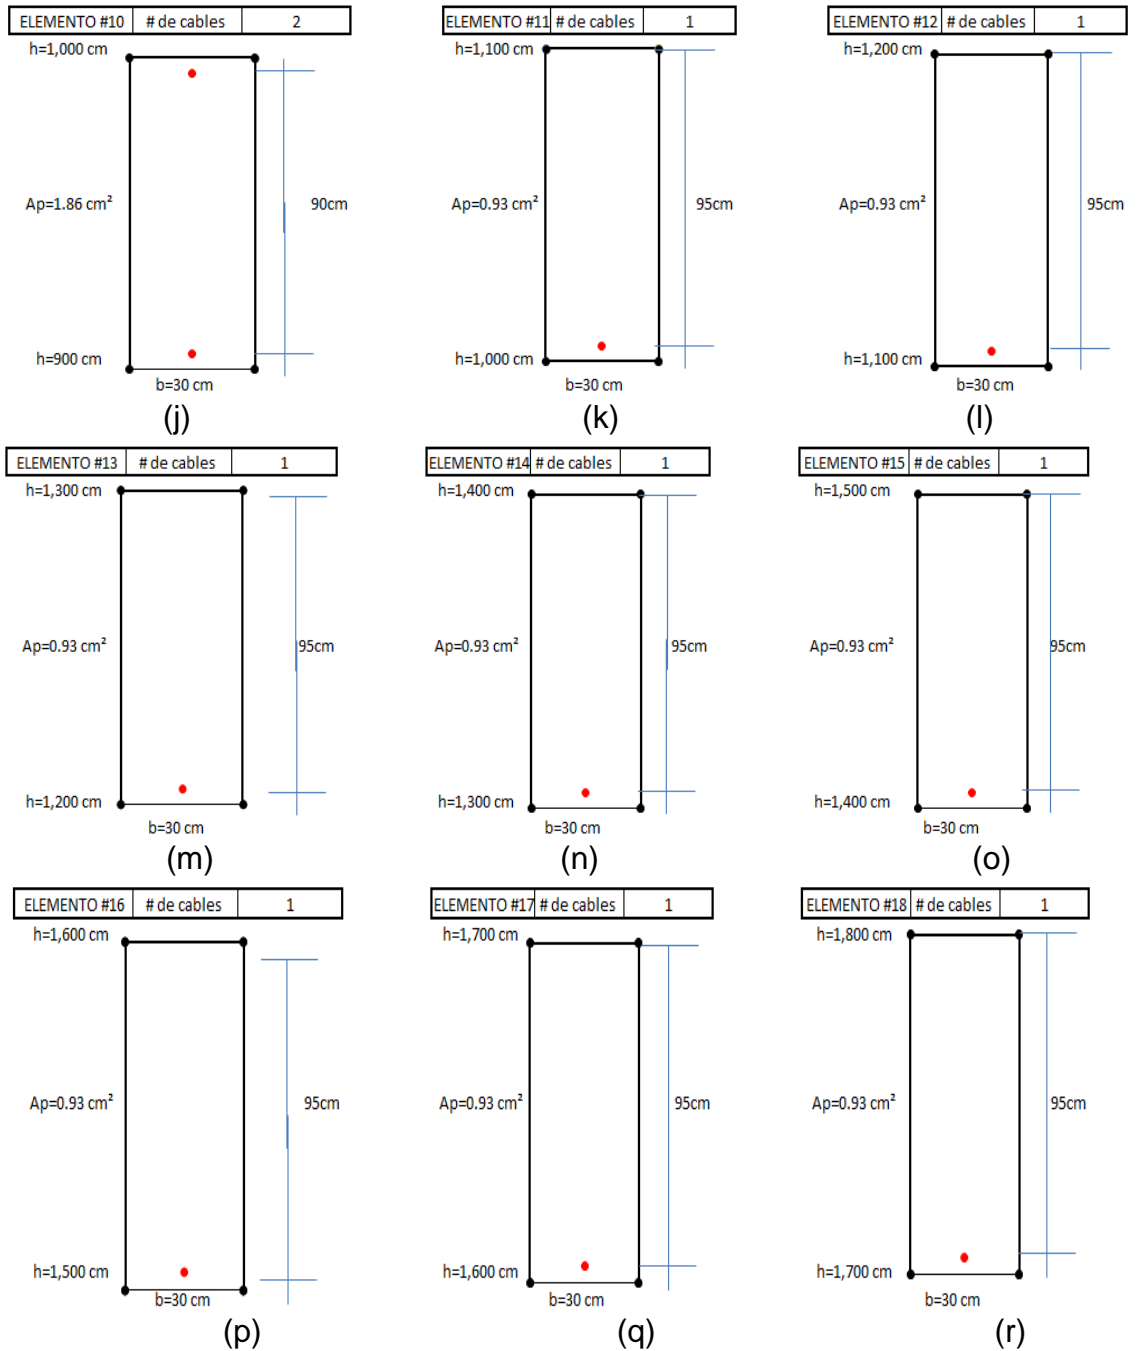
Distribución de Cables en elementos de Hormigón Pretensado.
